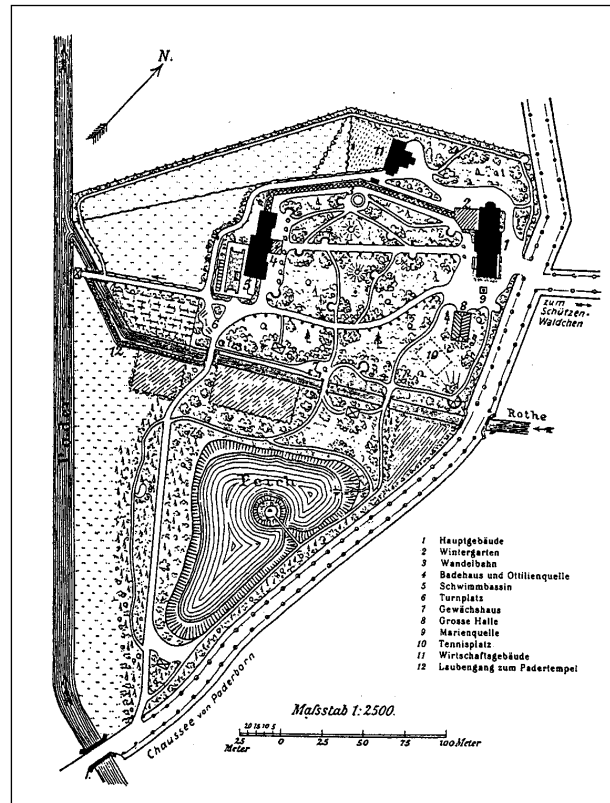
Lageplan der "Curanstalt Inselbad" mit Park (Heim, 1903)
